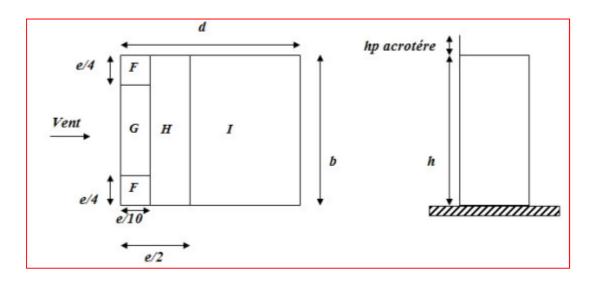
Répartition des zones de pression extérieure sur la toiture.
